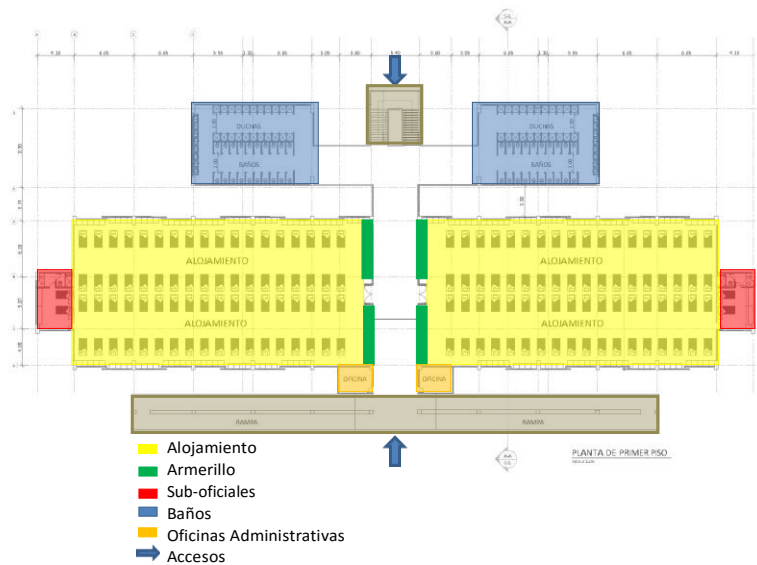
, Planta de primer piso barraca, Fuente: propia
